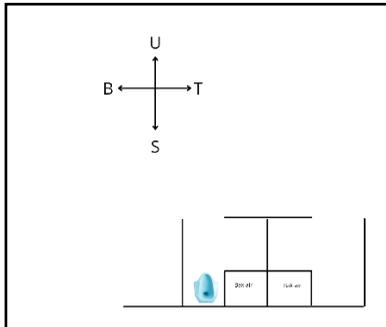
Arah bangunan MCK masjid Baitut Taqwa
